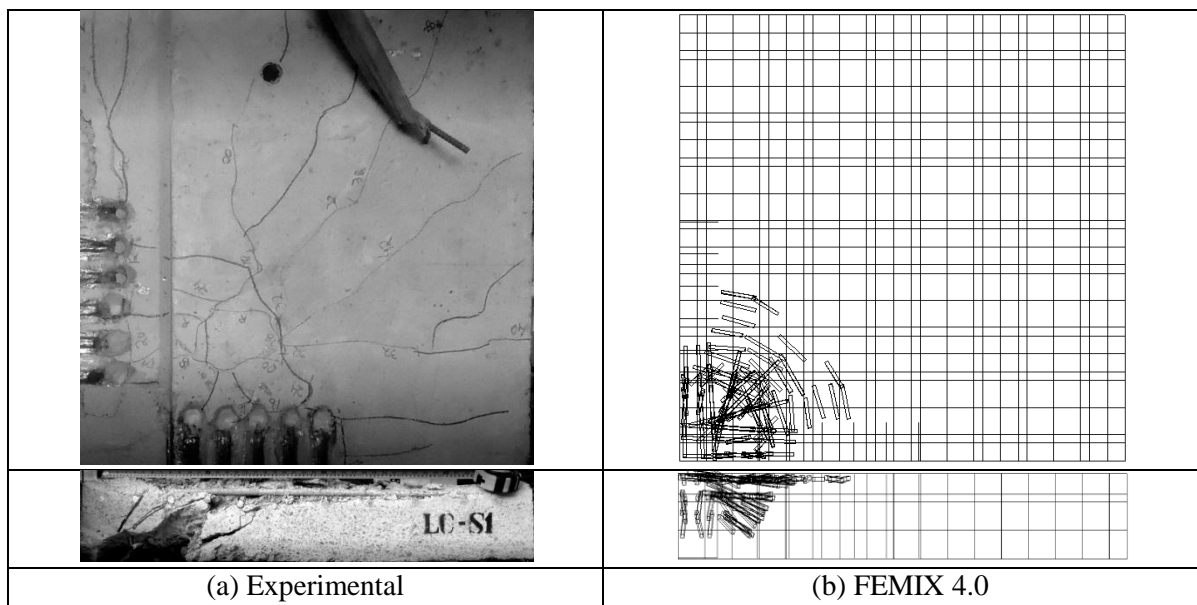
Padrão de fissuração - LC-S1 (FEMIX 4.0)
